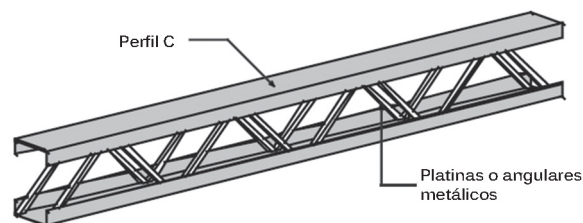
Viga de celosía compuesta por perfiles C y platinas.
